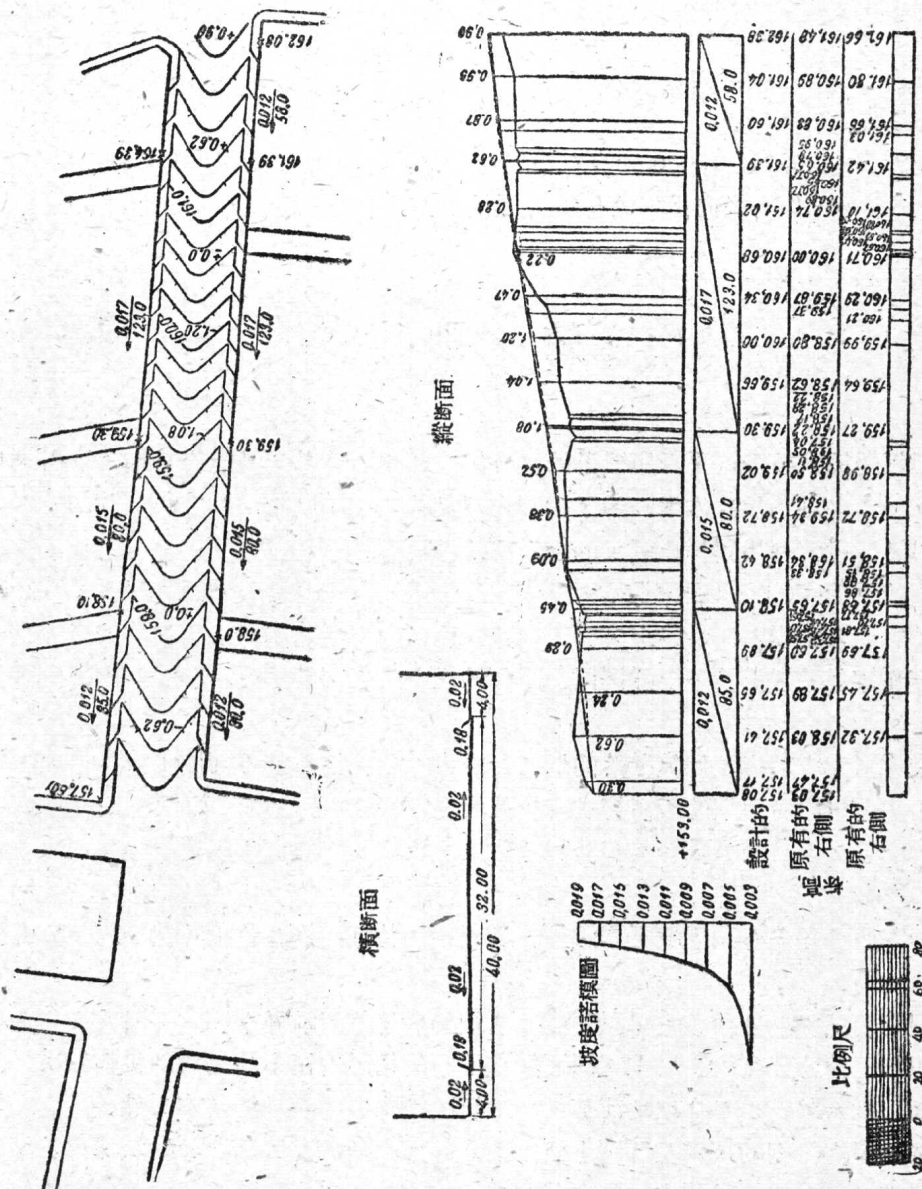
在平面圖上（有等高綫）和剖面圖上的街道断面
